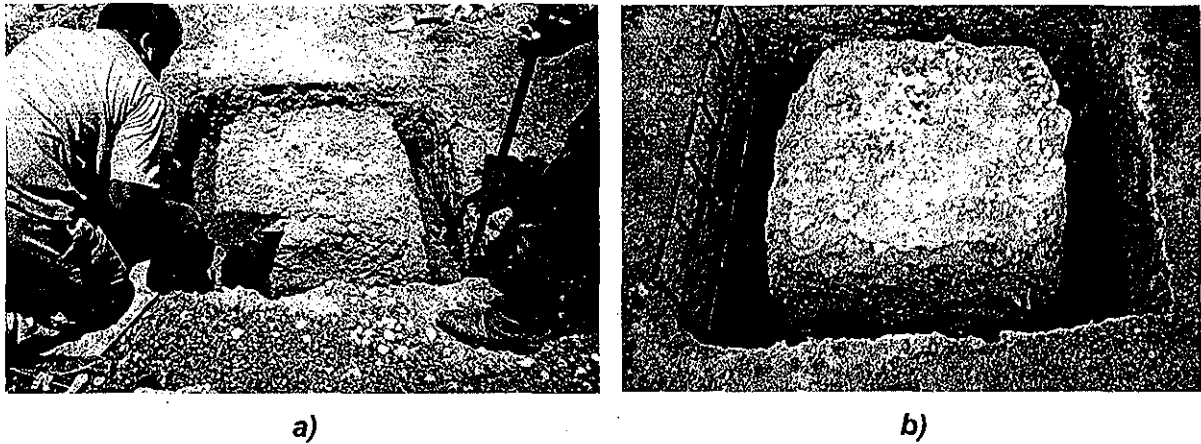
a) Excavación de las zanjas para alojar las contratraves de la base, b) núcleo de suelo intacto y colocación de las parrillas de acero en las paredes de las zanjas excavadas
